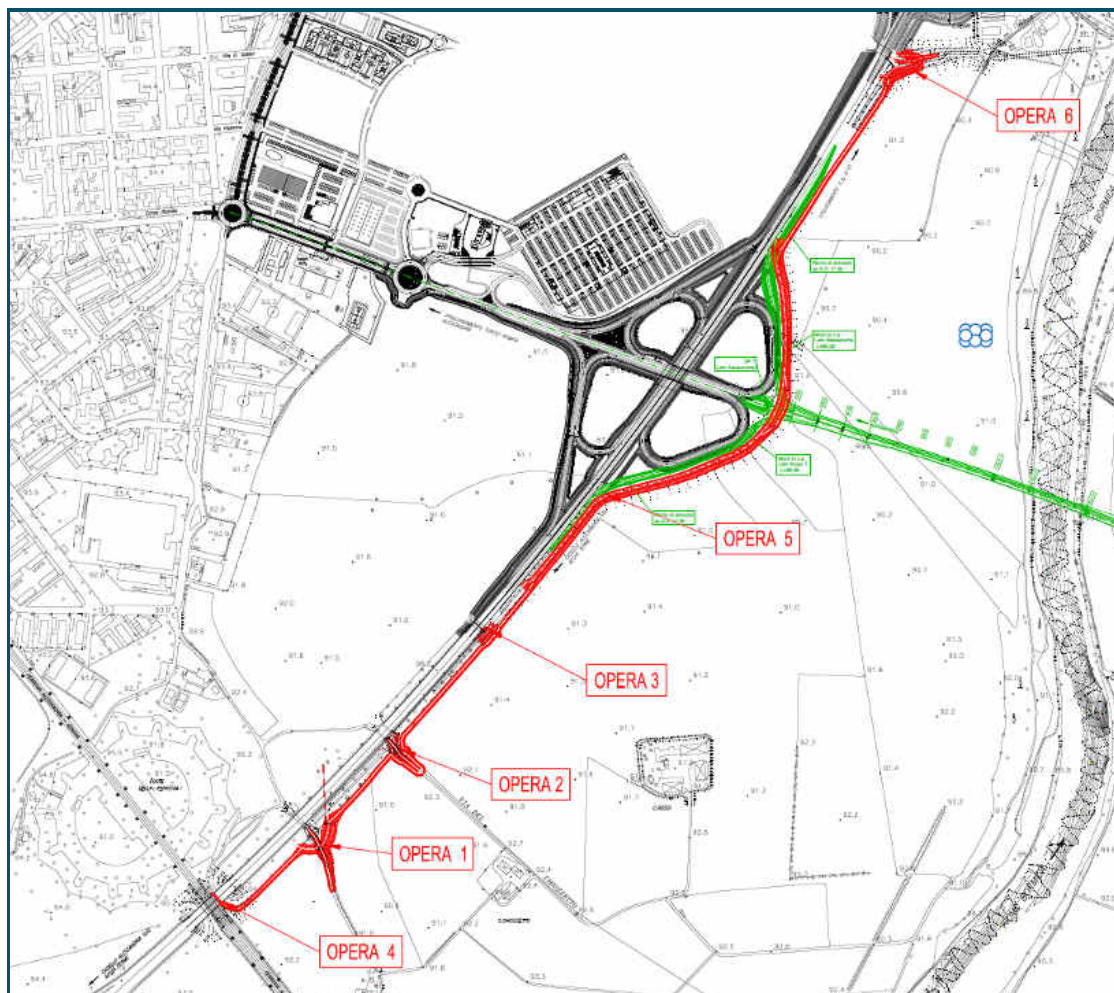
Stralcio planimetrico di progetto con individuazione su CTR degli interventi
